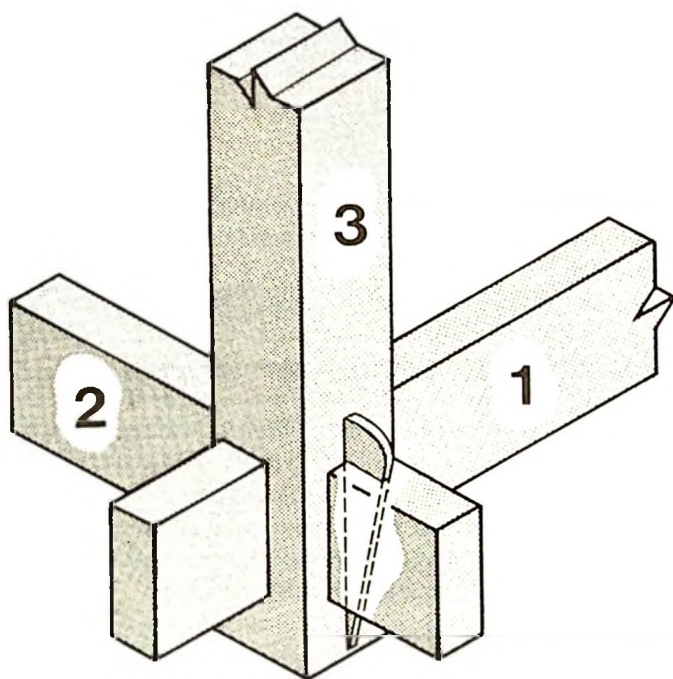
Detalhe do encaixe estrutural. 1, e 2. Vigas inferiores; 3. Pilar; 4. Cavilha.
